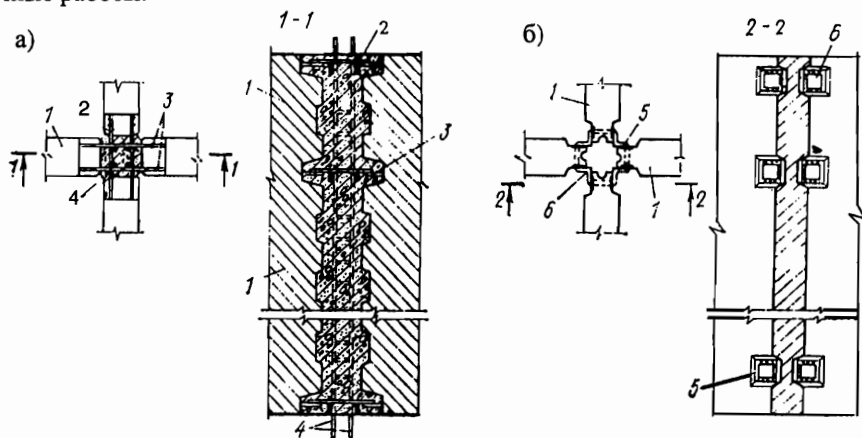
Вертикальные стыки внутренних стеновых панелей с арматурными (а) и жесткими (б) связями: 1 - внутренняя стеновая панель; 2 - арматурный вкладыш; 3 - арматурные выпуски; 4 - вертикальная связевая арматура; 5 - закладная деталь; 6 - уголок
